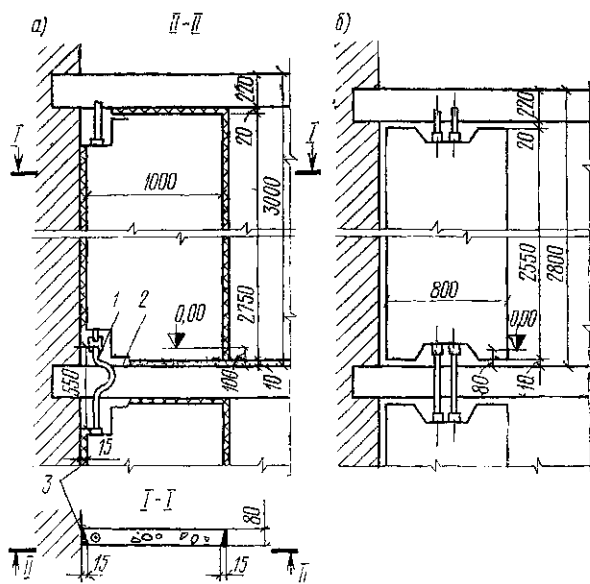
Установка и сопряжение перегородочных отопительных панелей
